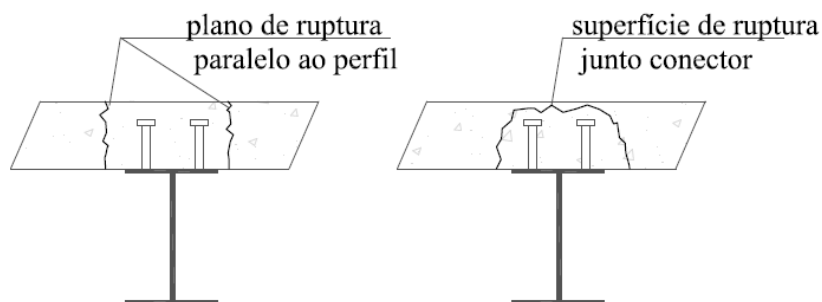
Ruptura do concreto devido ao cisalhamento longitudinal.
